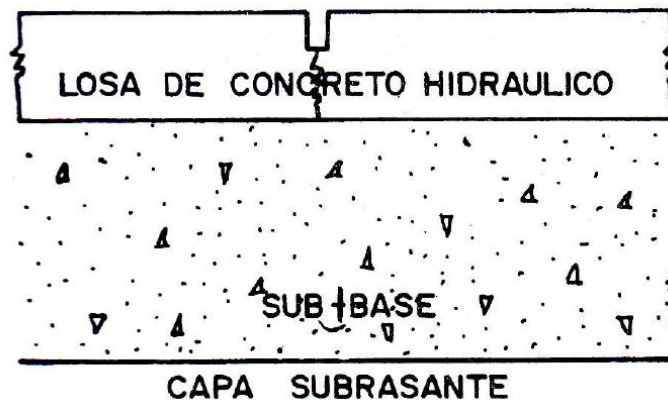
Esquema de las capas que forman un pavimento rígido, construido sobre la capa subrasante.
